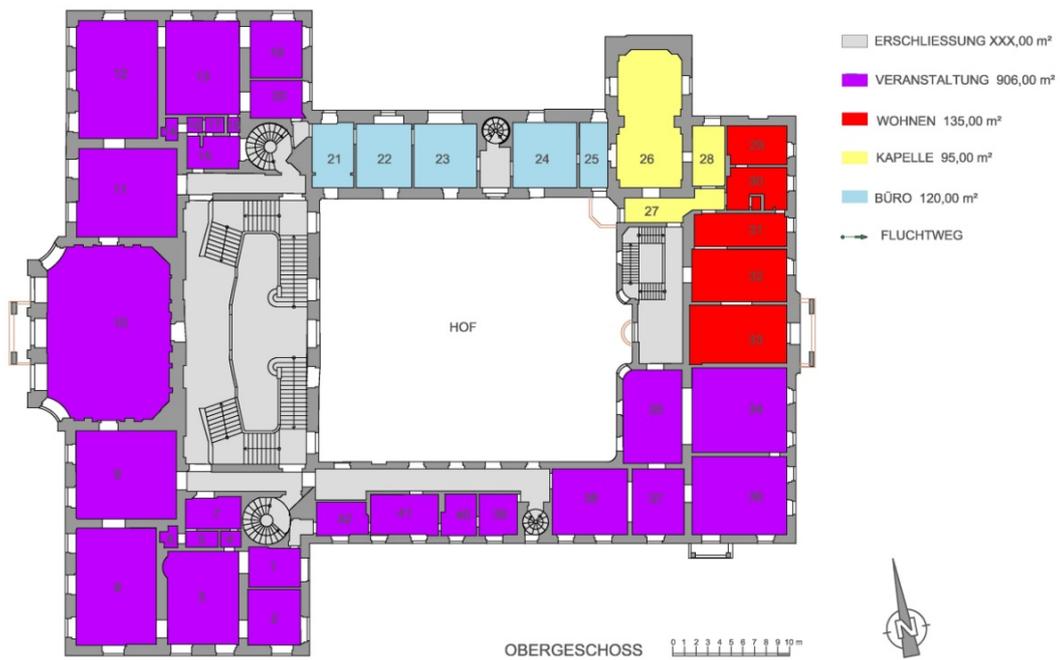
zeigt den Grundriss des Schlosses Eckartsau
